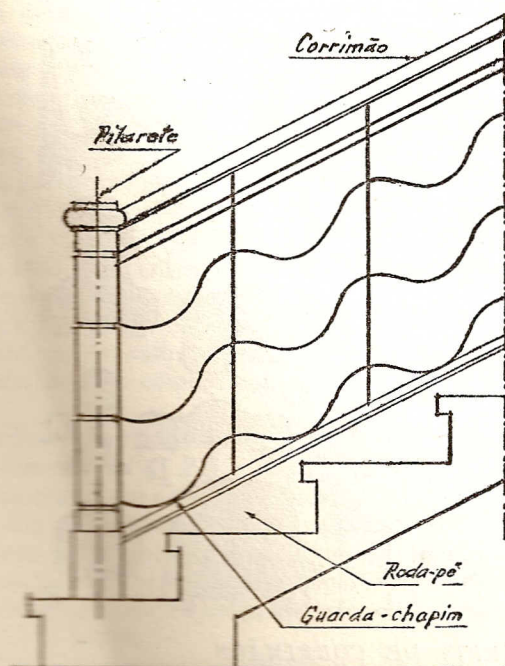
GRADE DE FERRO COM PILARETE DE MADEIRA
